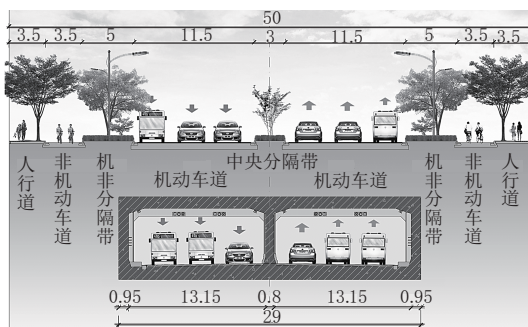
康良快速路东段地道 B-B 断面标准横断面布置图(单位:m)
